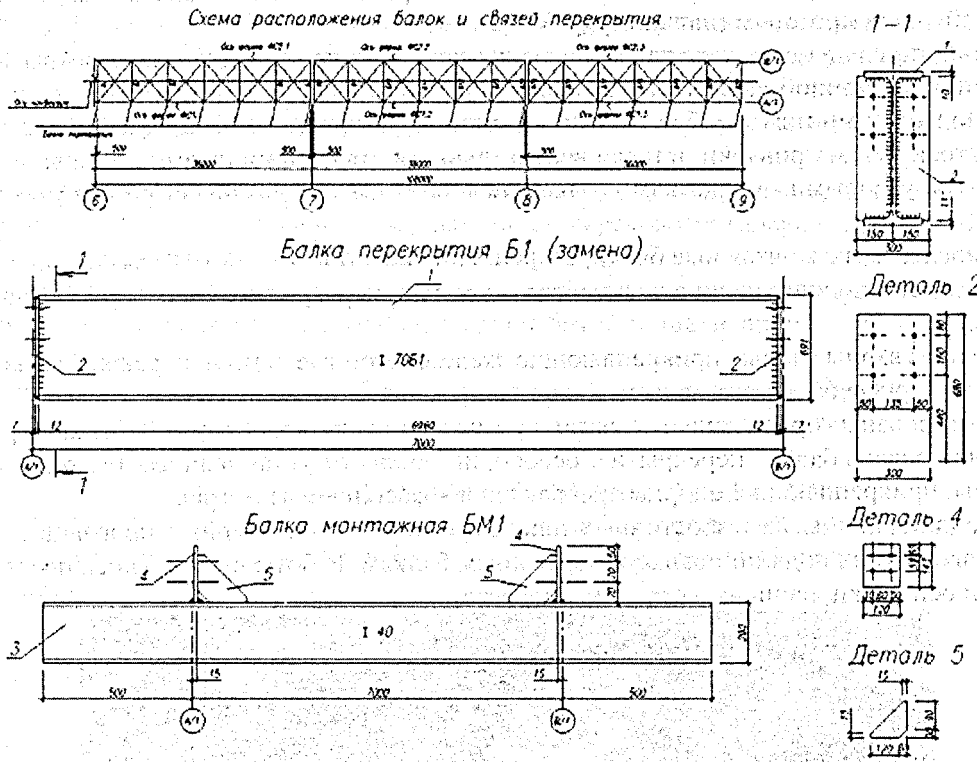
Балка замены Б1 и монтажная балка БМ1
